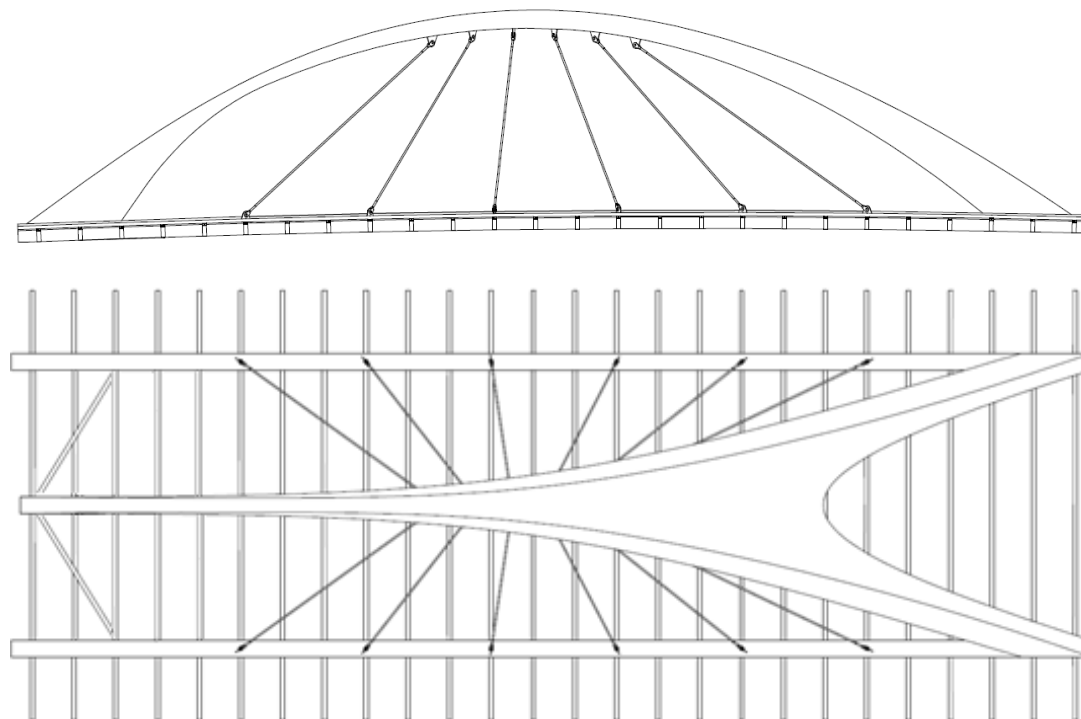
ALZADO Y PLANTA ESTRUCTURALES DEL PUENTE.
